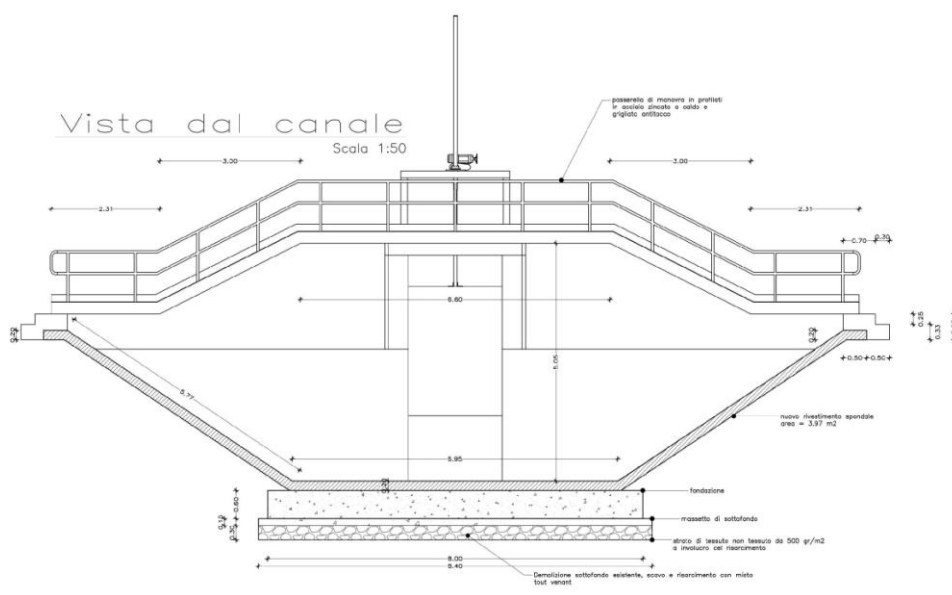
Prospetto dell'opera di sezionamento vista dal canale (a monte)
